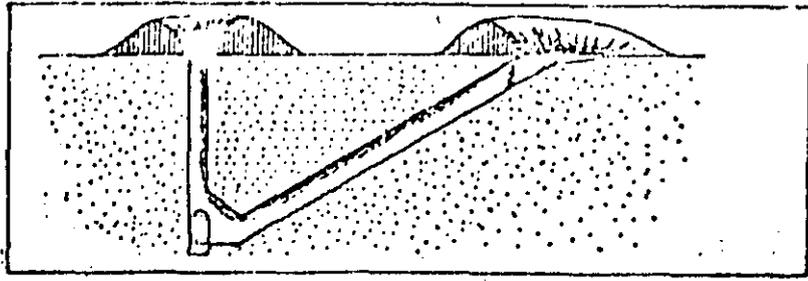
Corte transversal de un Qanat visto en la dirección del eje del tunel (Ref. Sandström)
